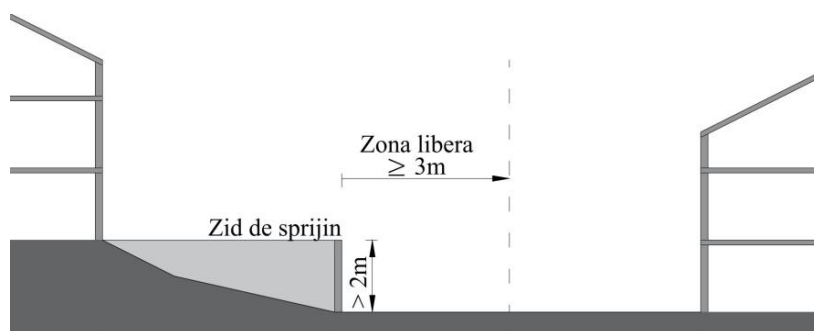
Perete de sprijin cu relevanță pentru zona liberă
